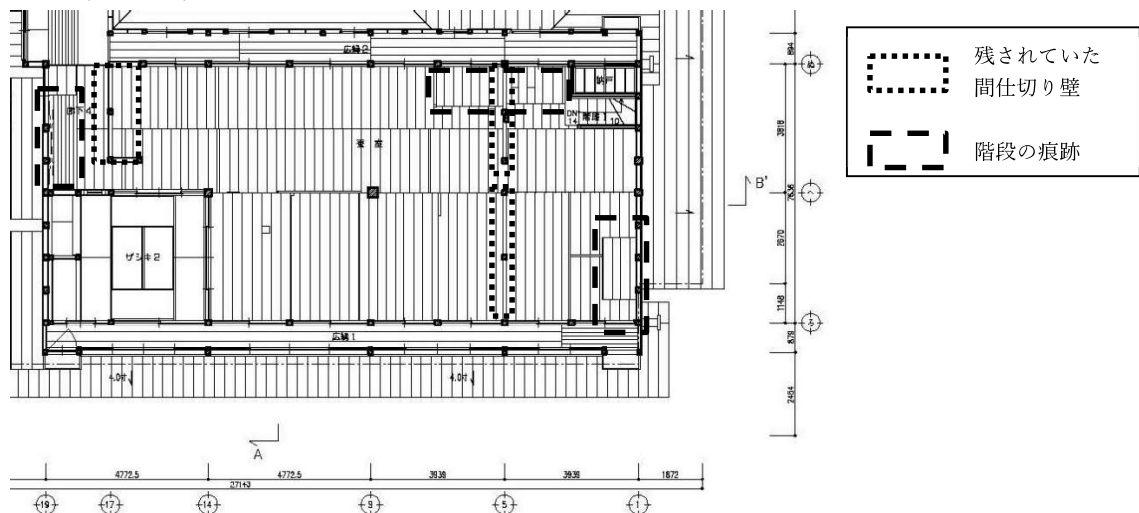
改修前 2階平面図 残されていた間仕切り壁・階段の痕跡
